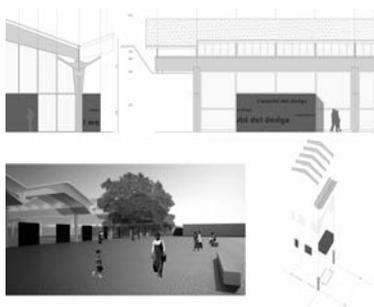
Dettaglio di una campata tipo sul prospetto sud: prospetto frontale e laterale, esploso assometrico e modello virtuale, progetto di rifunzionalizzazione
